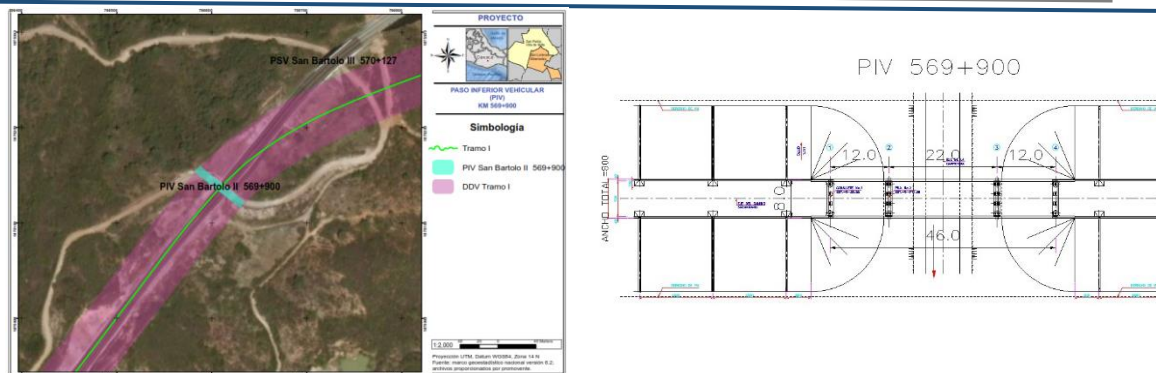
Proyecto en planta del PIV 569+900 San Bartolo II.
